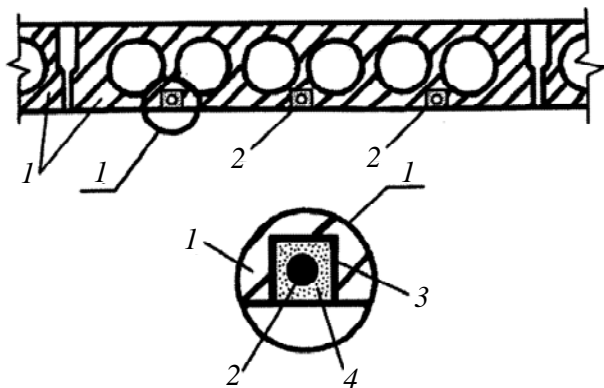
Усиление плиты перекрытия установкой дополнительной арматуры на полимеррастворе:
